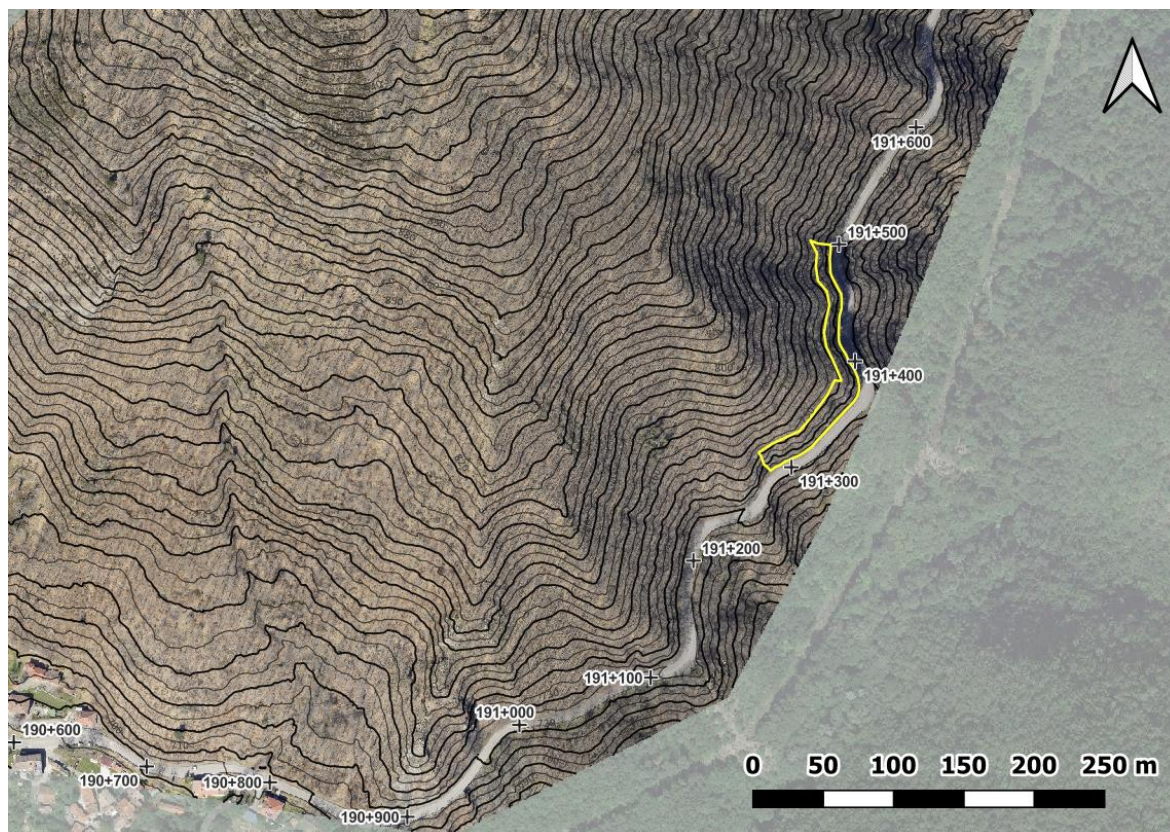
Ubicazione planimetrica dell'area interessata dall'intervento Po.025. Scala grafica
